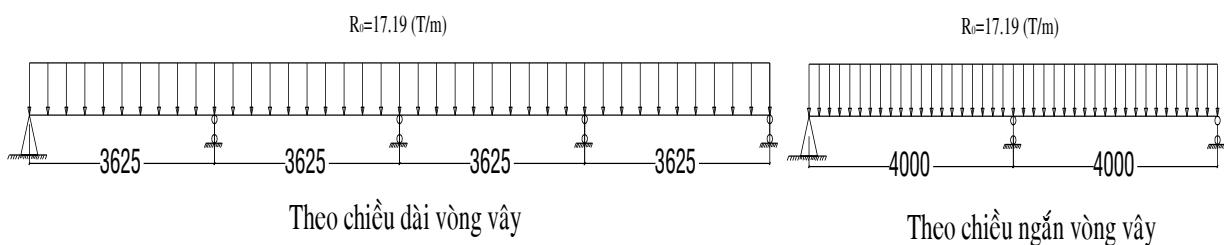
Sơ đồ bố trí nẹp ngang và thanh chống.
